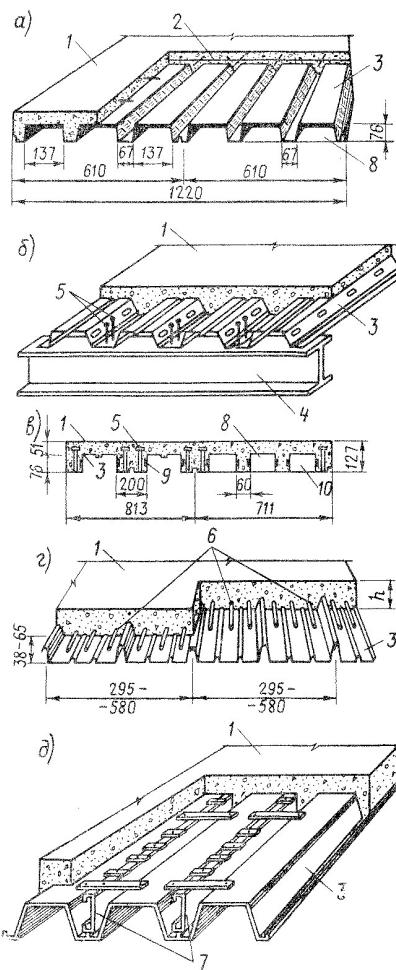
Схема конструкции железобетонного перекрытия с профицированной листовой арматурой
